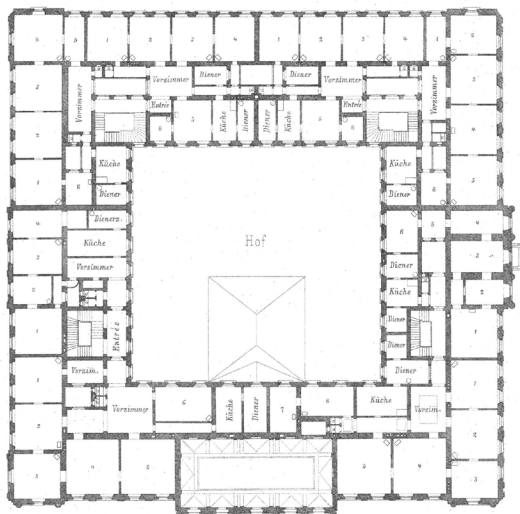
Heinrich Ferstel: Administrations-Gebäude des Österr.Ungar. Lloyd, Grundrisse, Triest, in: *Allgemeine Bauzeitung* 48, 1883.
